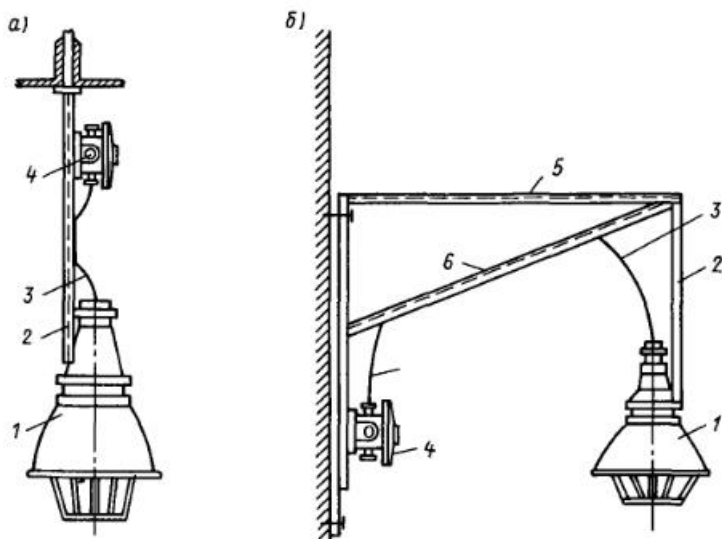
Крепление светильников при открытой прокладке кабелей а — на подвесе, б — на кронштейне
